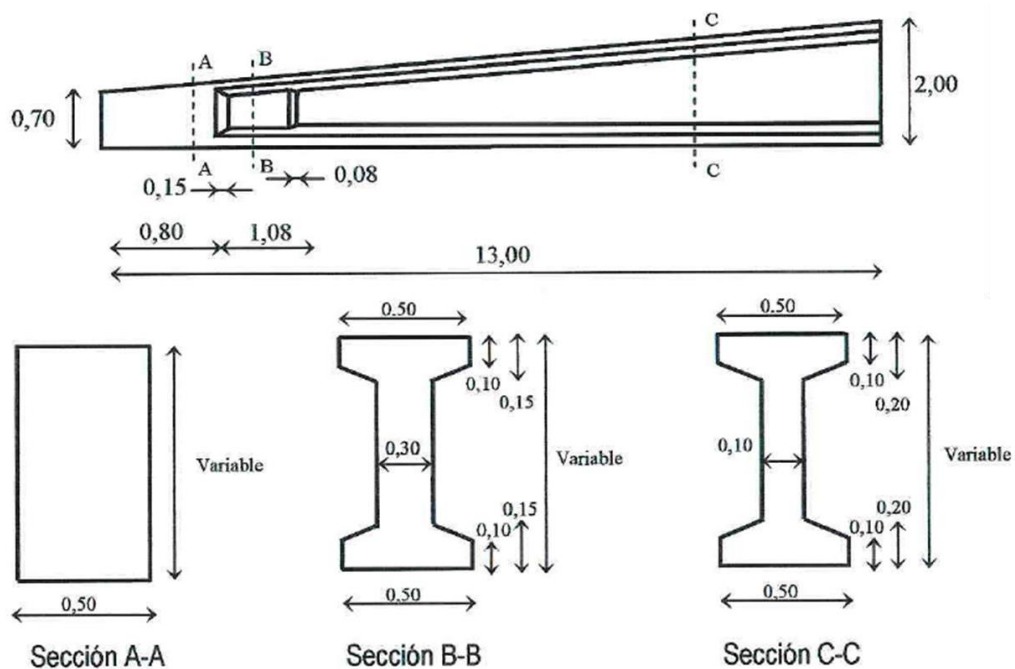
Dimensiones Viga Seleccionada (fuente: Gilva)
